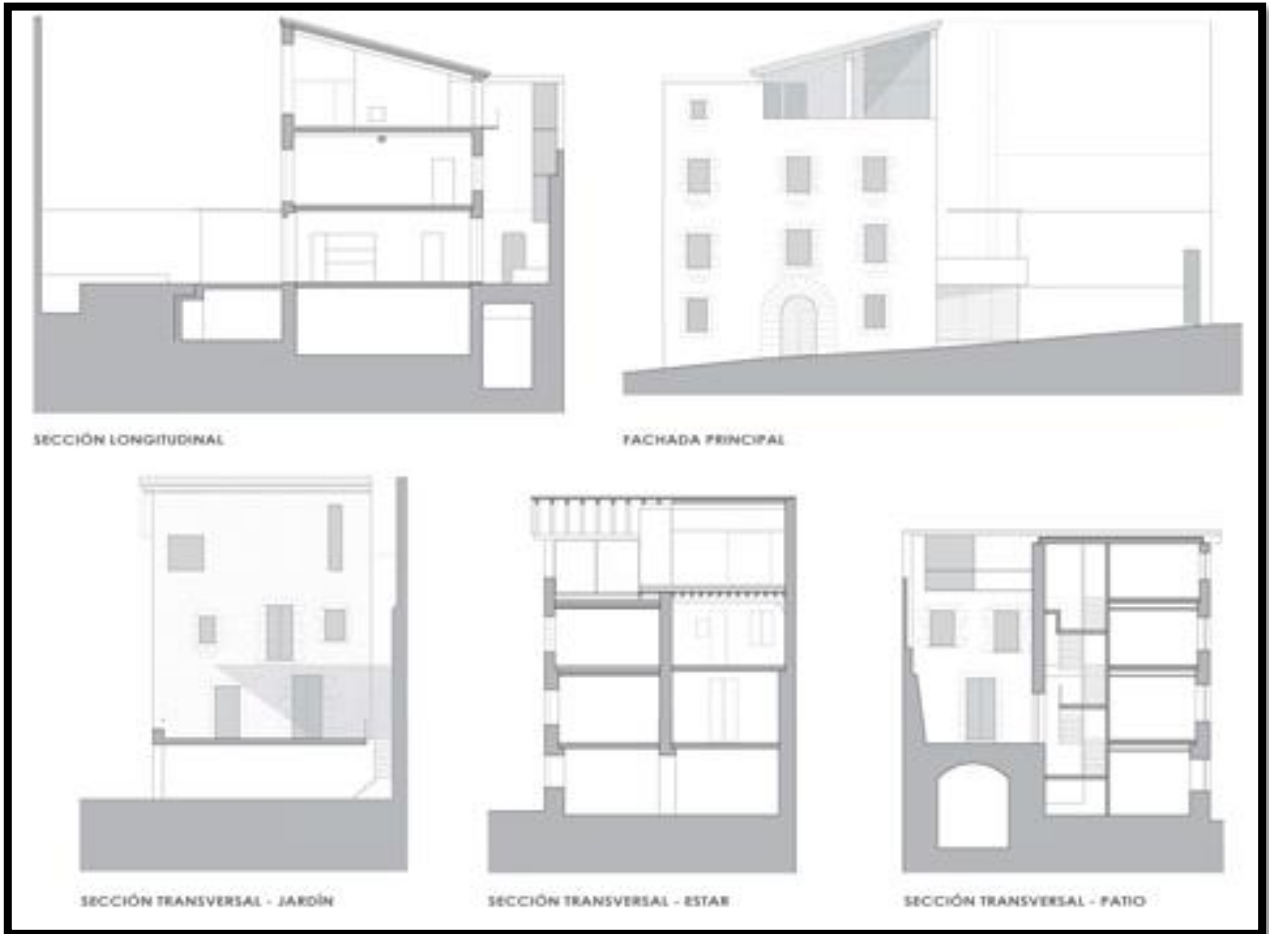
Plantas del proyecto Hicarquitectura Girona España 2006
